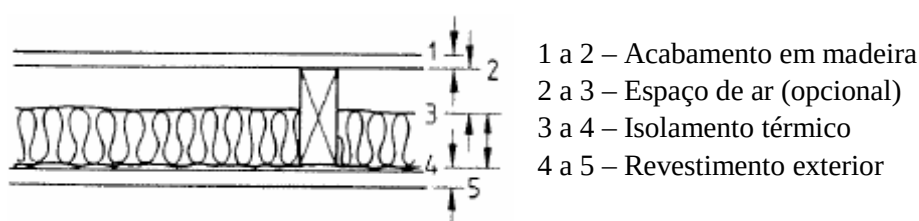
Constituição de pavimentos exteriores elevados com acabamento em madeira e estrutura de suporte descontínua [2]
